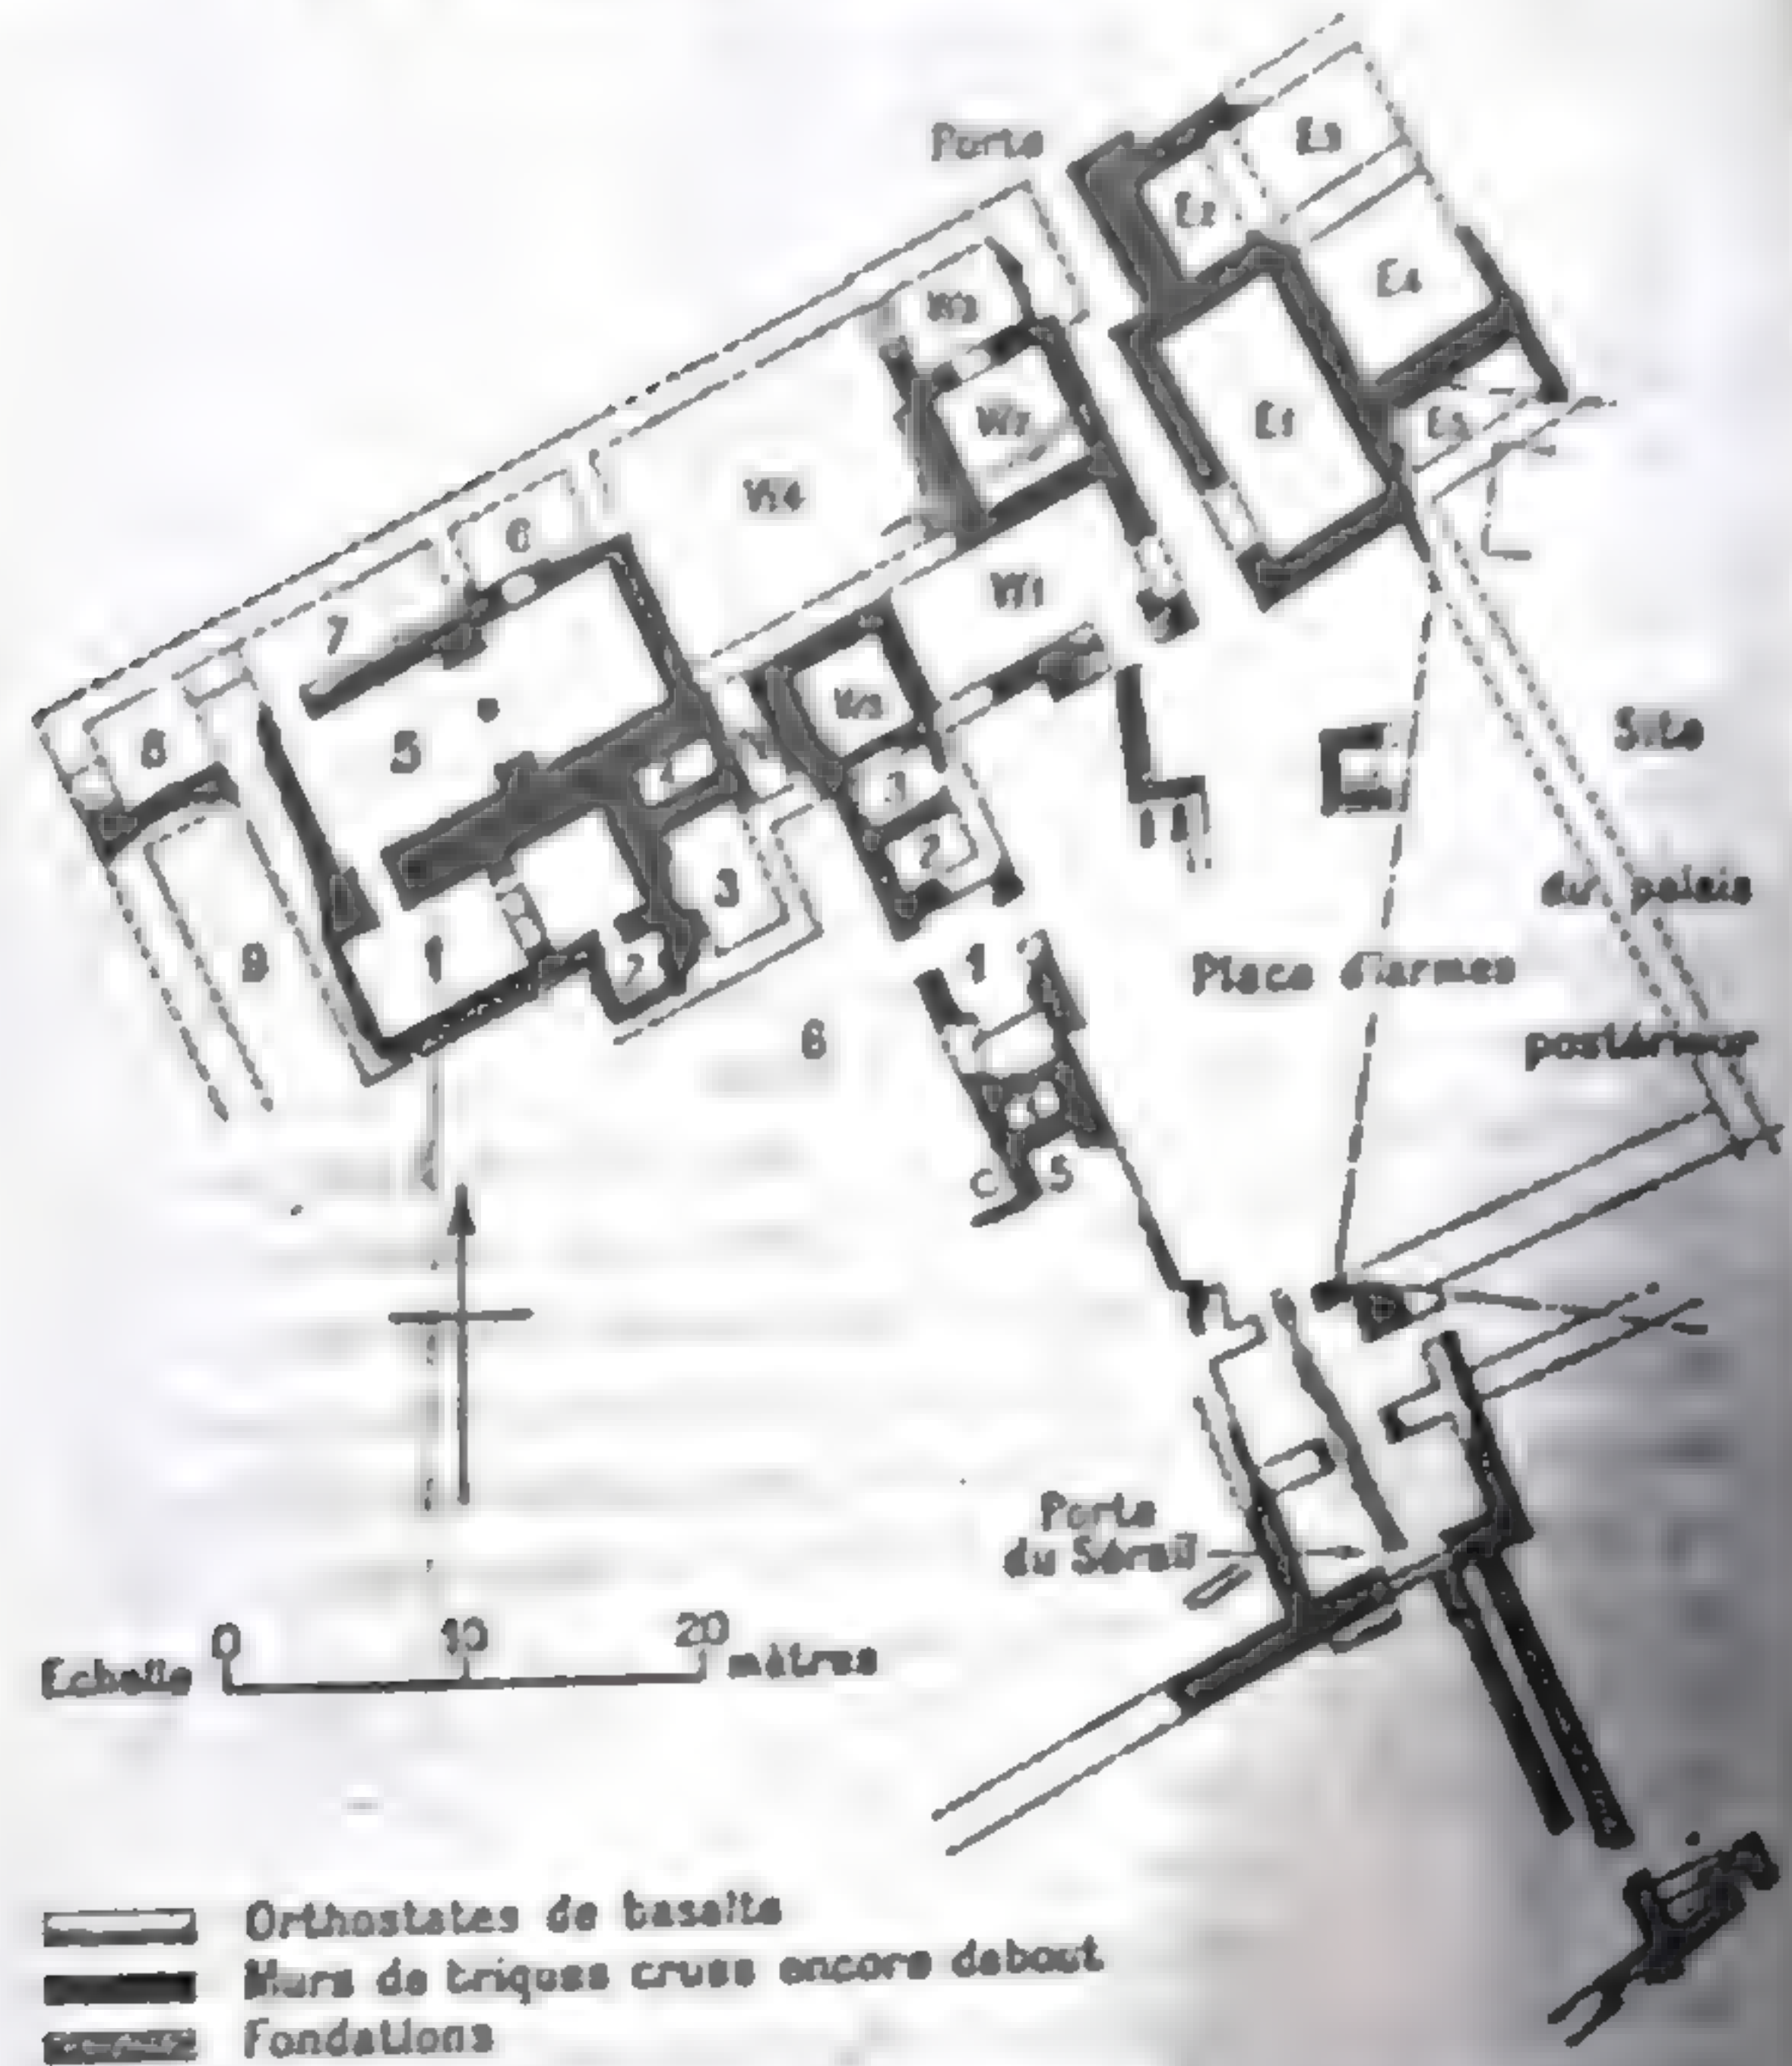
Plan de la citadelle et de la porte nord-est de la ville du Niveau IV.
